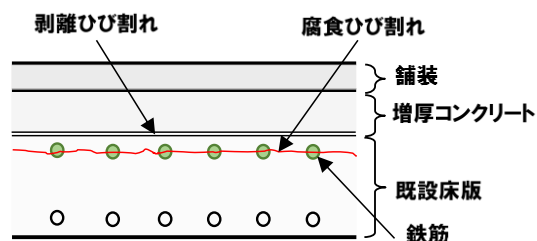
上面増厚後に顕在化した RC 床版のひび割れ
